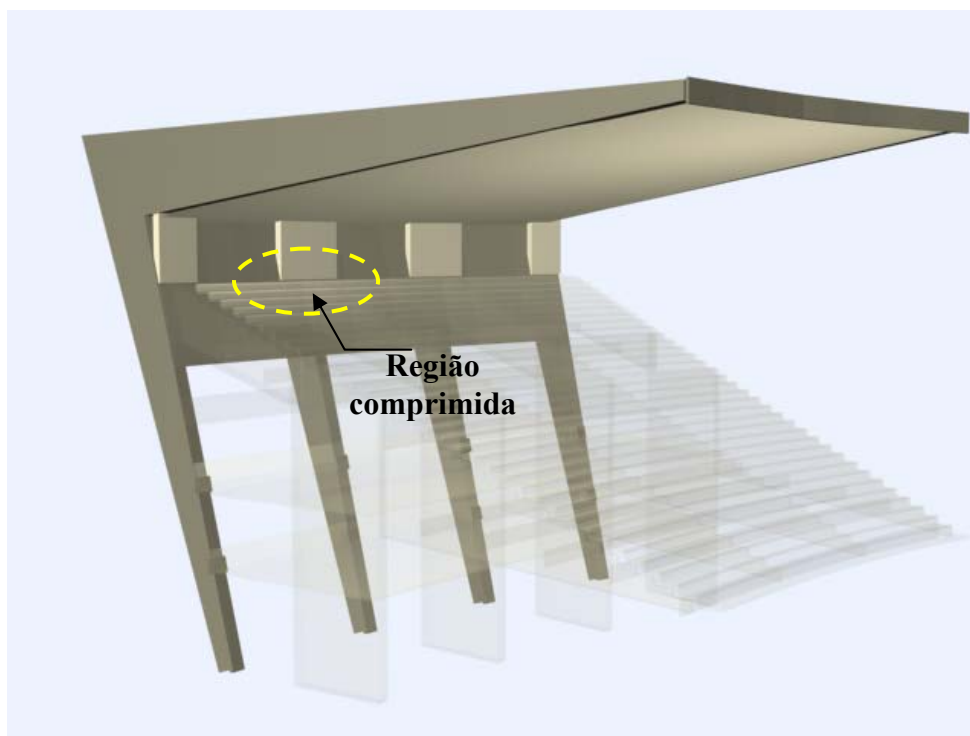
Croquis mostrando a mesa comprimida do pilar externo apoiando-se na viga da arquibancada e na vigaparede
